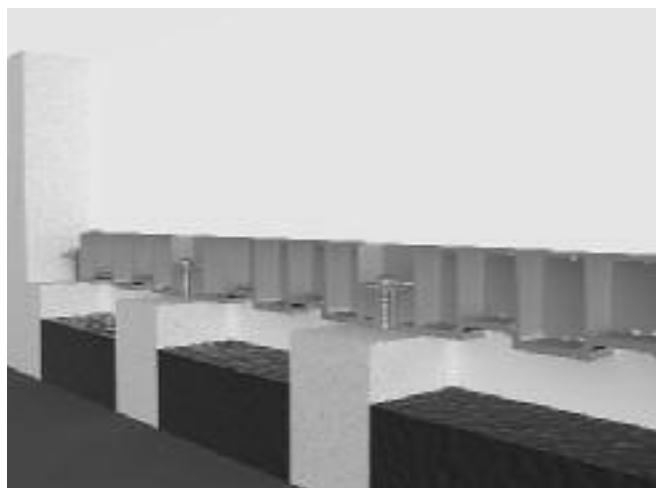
Sección del piso filtrante montado sobre los muretes donde se aprecian los anclajes y las estructuras de refuerzo interiores
